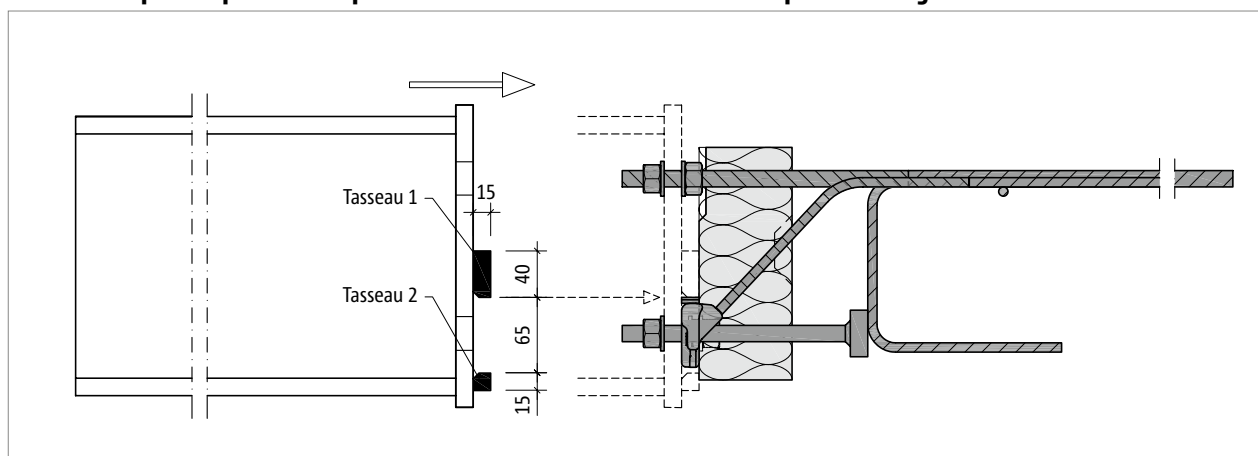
Schöck Isokorb® T type SK : montage de la poutre en acier
